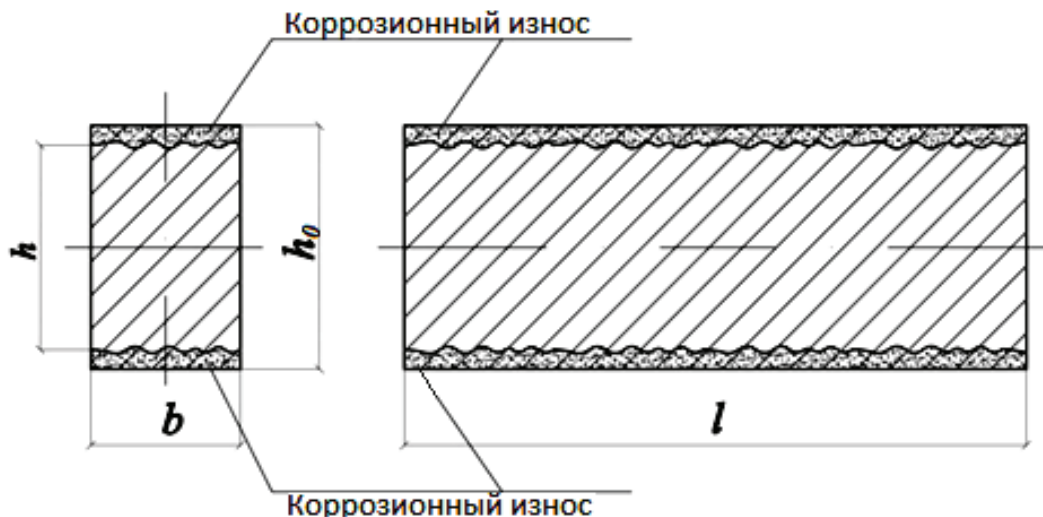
Коррозионный износ металлической балки прямоугольного сечения
